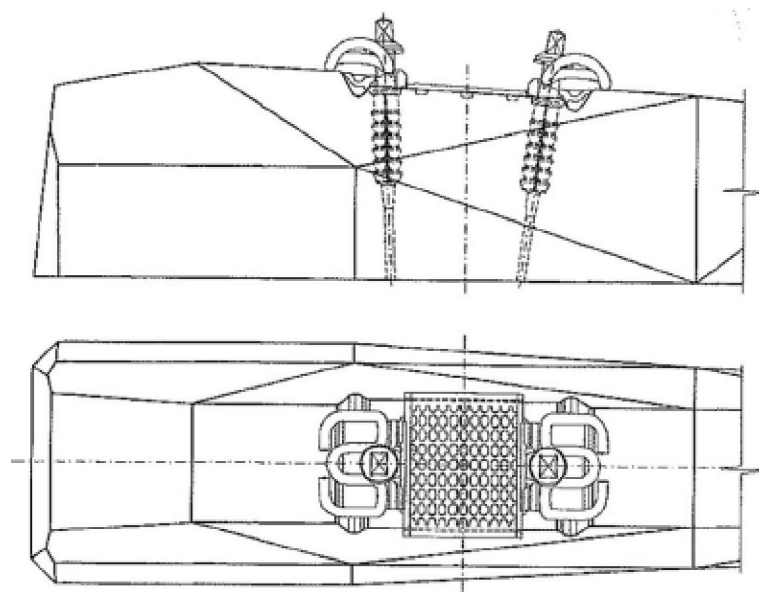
Detalls de la planta superior i alçat de la travessa, extret de [7]
